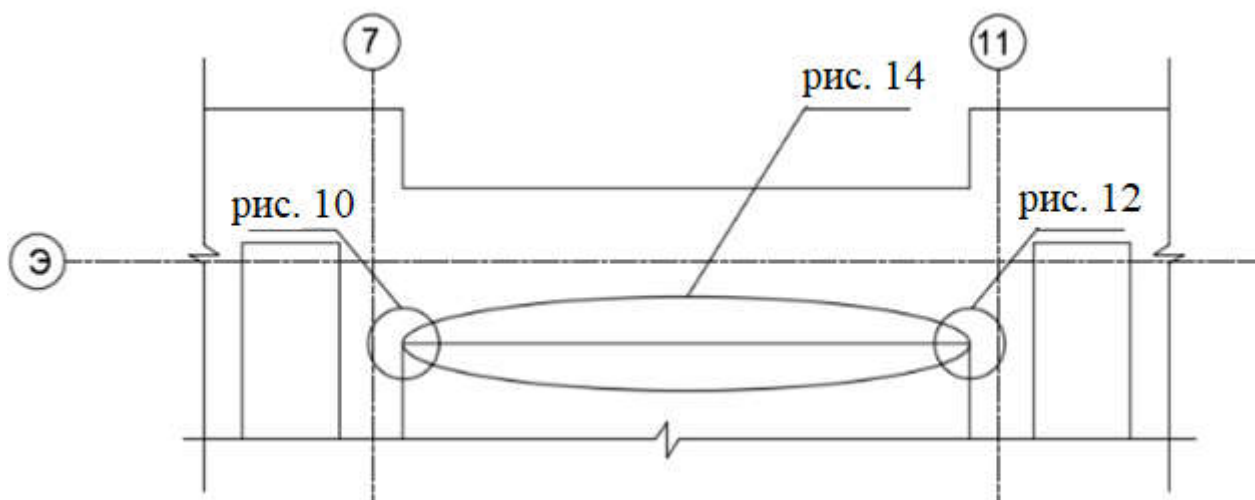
Схема нарушений фундаментов по оси Э в осях 7-11
